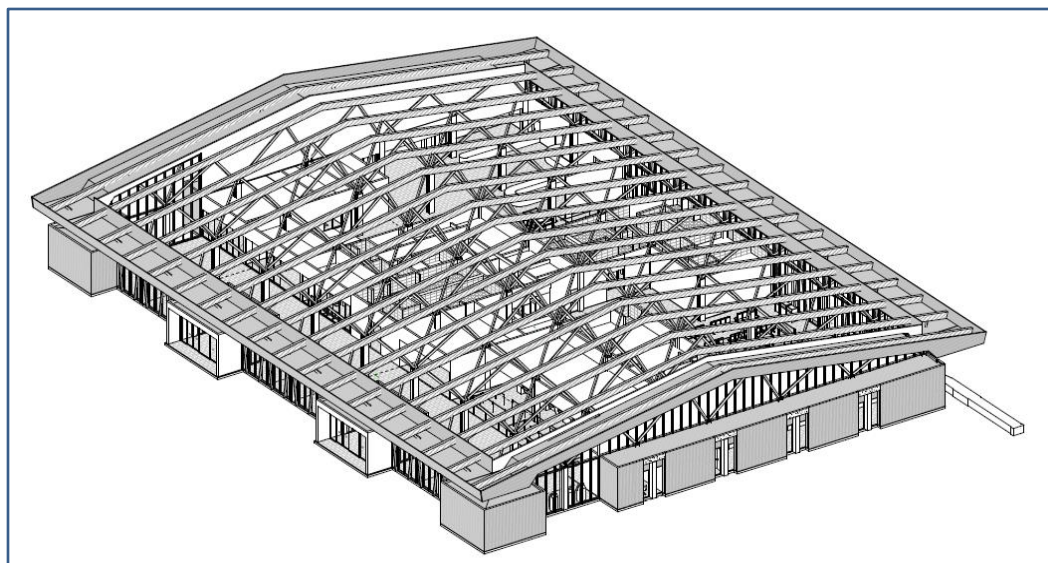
Vivienda en Lago. Tetrápodos y Madera Laminada
